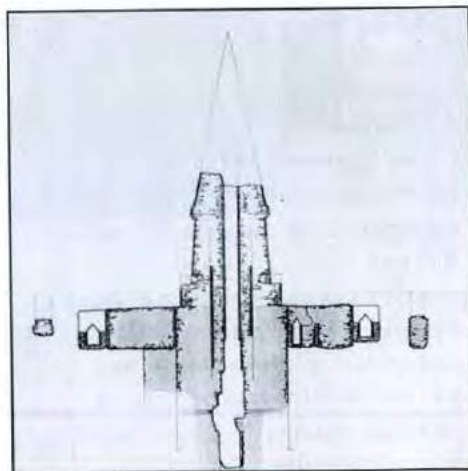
Roma: Meta Sudans prospetto realizzato da Gatti
